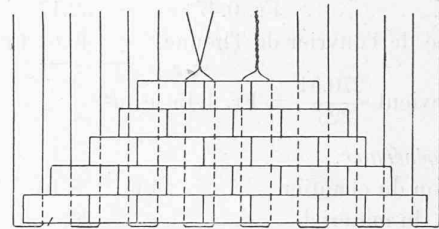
Disposition des étriers en fil N° 20 (4,4 mm.) assemblant la cuirasse de faible hauteur.
